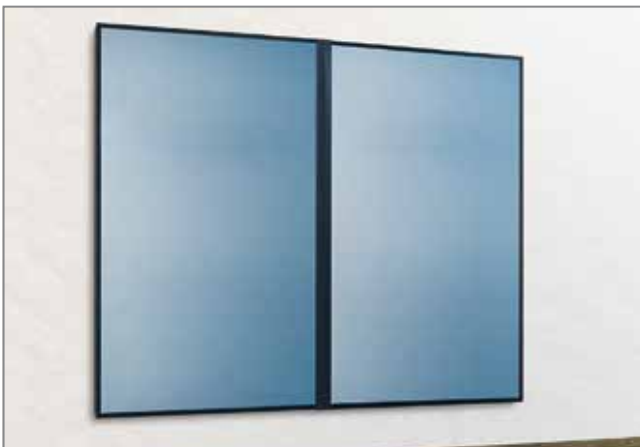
Fassadenparalleles Montagesystem für Flachkollektoren
